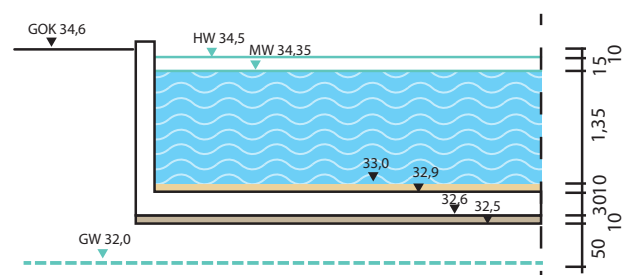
VA1: Wasserbecken mit Betonboden: Schnitt
